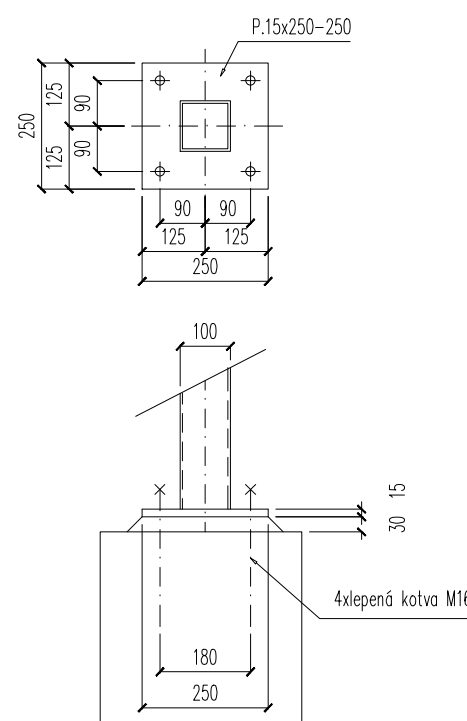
DETAIL KOTVENÍ SCHODNIC NA ZÁKLADU
